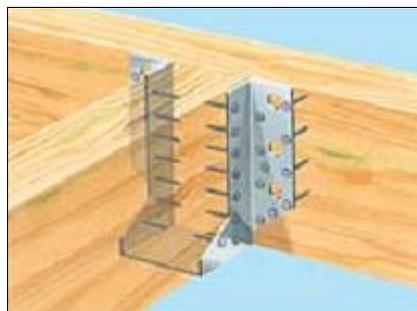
"Cruzetas" de ligação madeira/madeira, madeira/alvenaria ou betão
